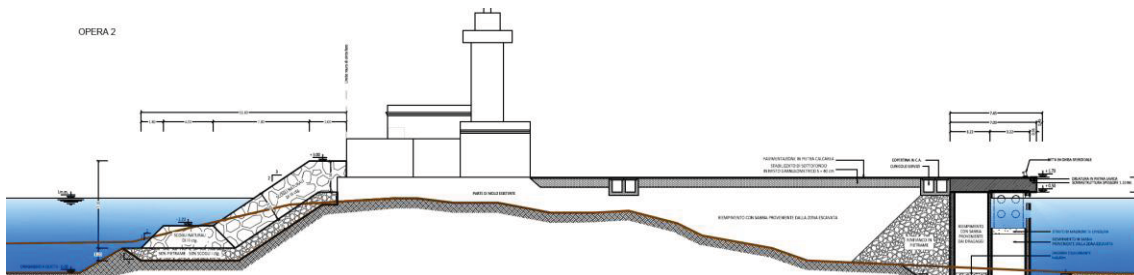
Sezione tipo di intervento presso il molo Colombo
